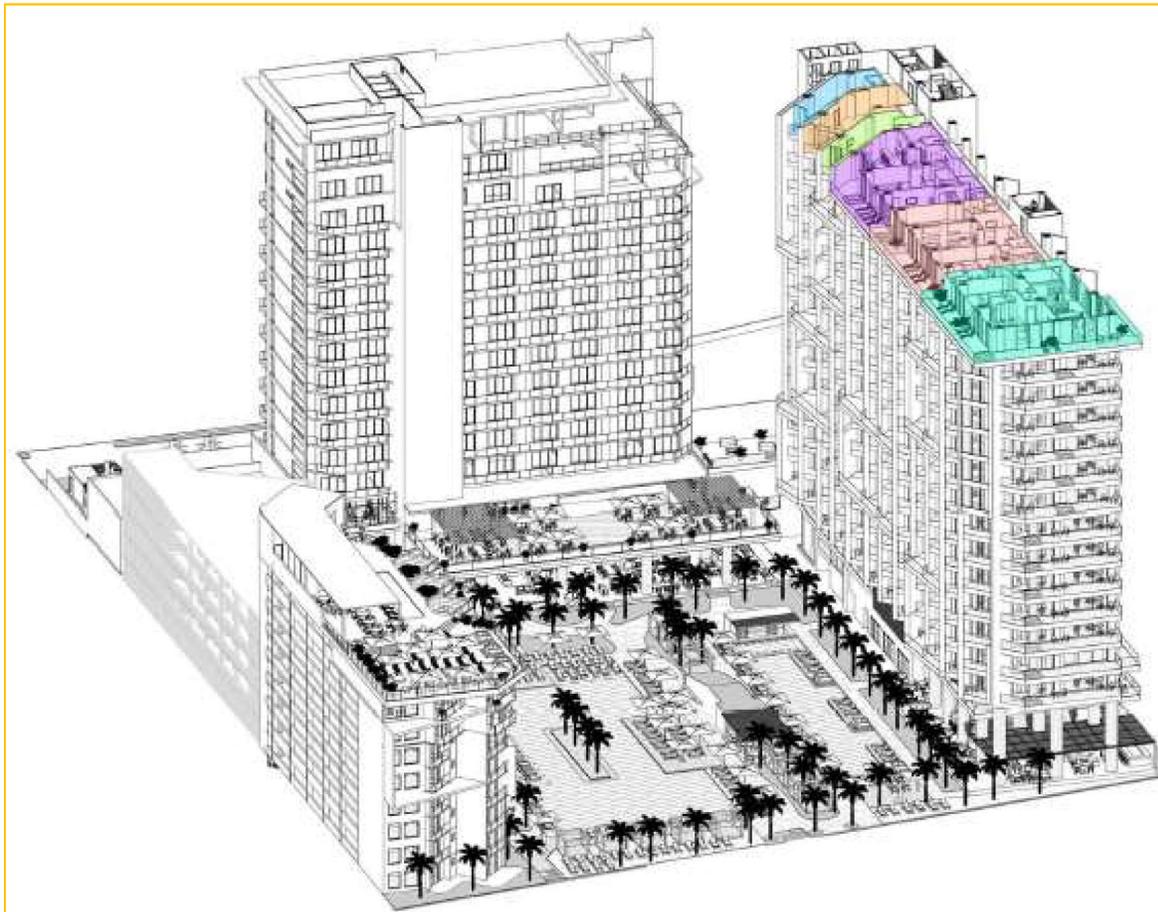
Diseño arquitectónico de la planta del Nivel 09, Roof Garden.
